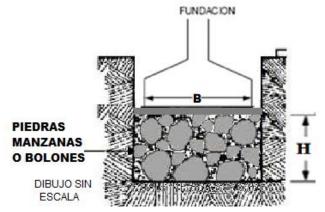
Mejoramiento de suelos con piedras debajo de la zapata
